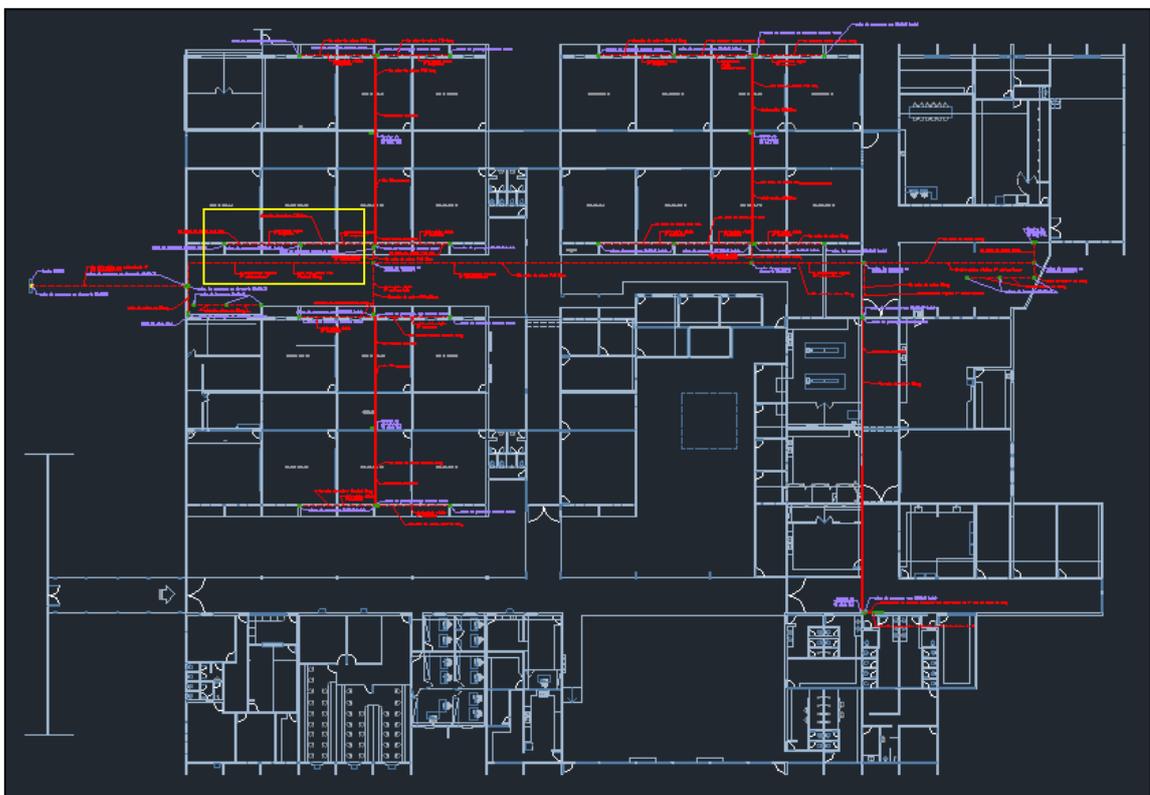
Planta baixa ao término do projeto elétrico João Pessoa
